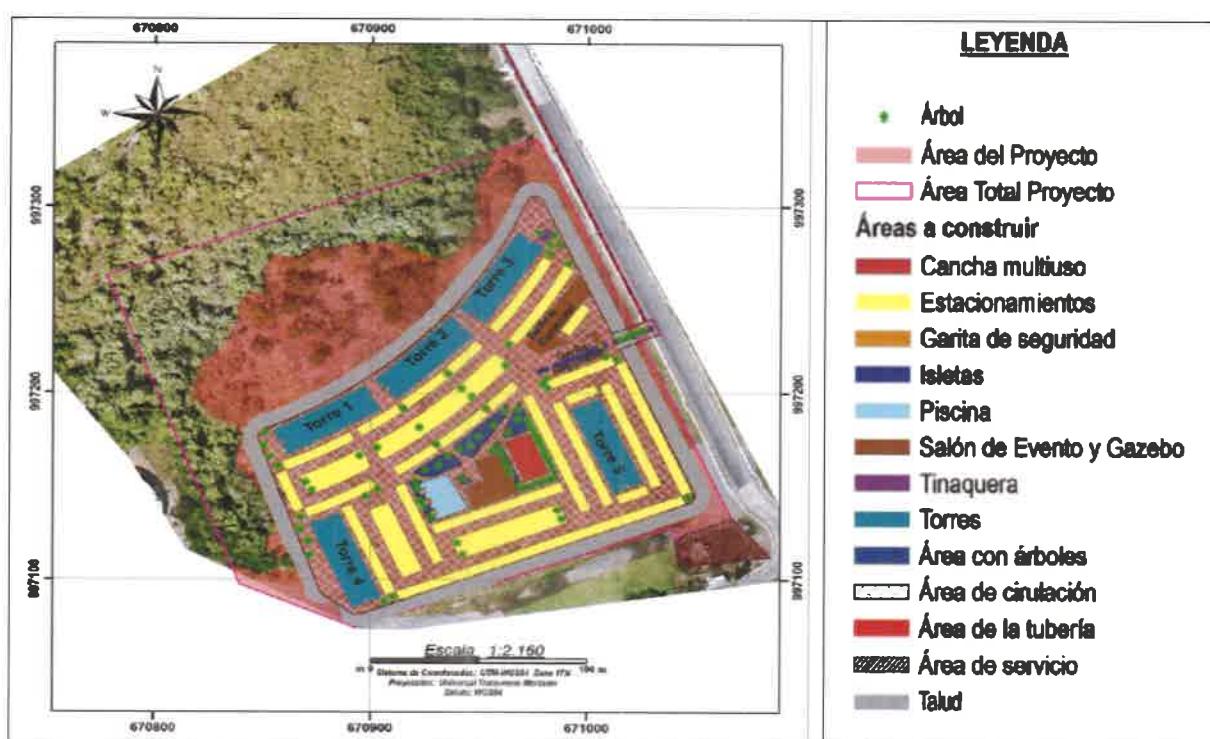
Superficie de construcción del proyecto, 25,556.22 m².
